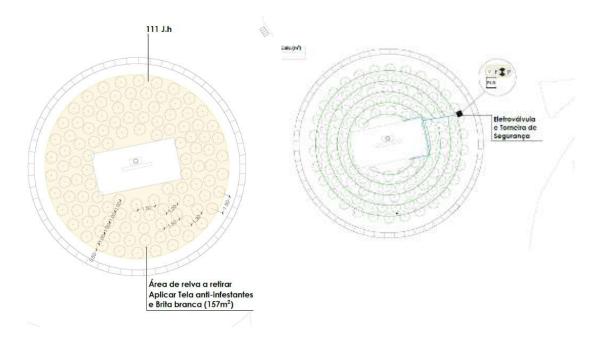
Imagens retiradas do Plano de Plantação e de Rega a aplicar na rotunda Comandante Sérgio Batista.
